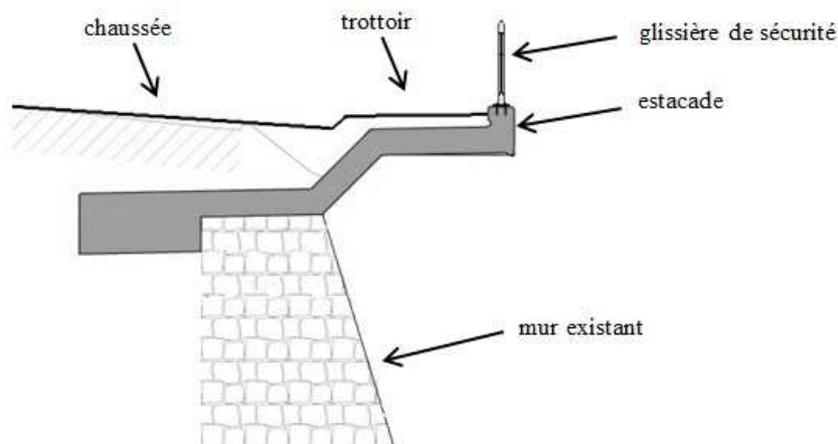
Estacade sur le ruisseau de Brent, coupe-type sur le mur existant en maçonnerie
